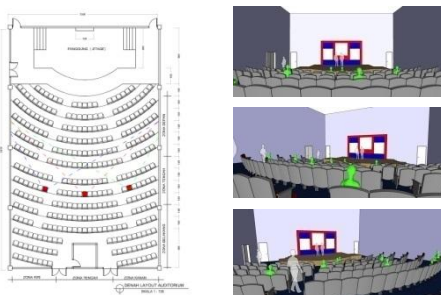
Penampang ruang berdasarkan lebar dan panjang ruang
